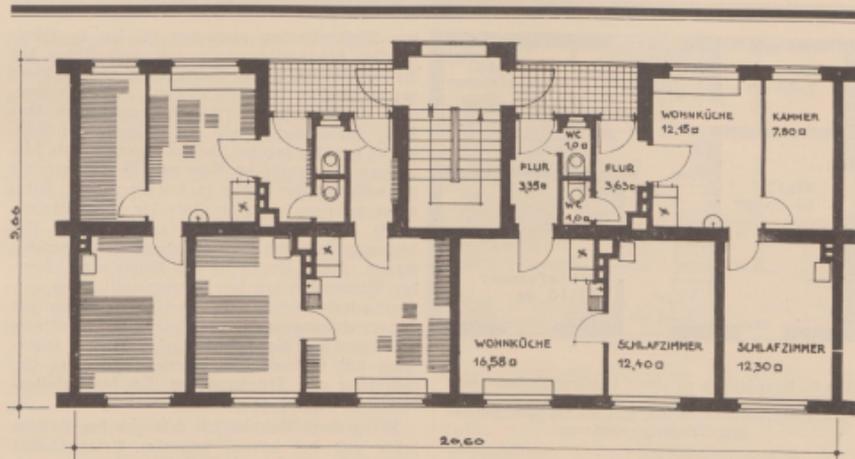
Grundrißtyp zu einem städtischen Miethaus mit Kleinwohnungen.
